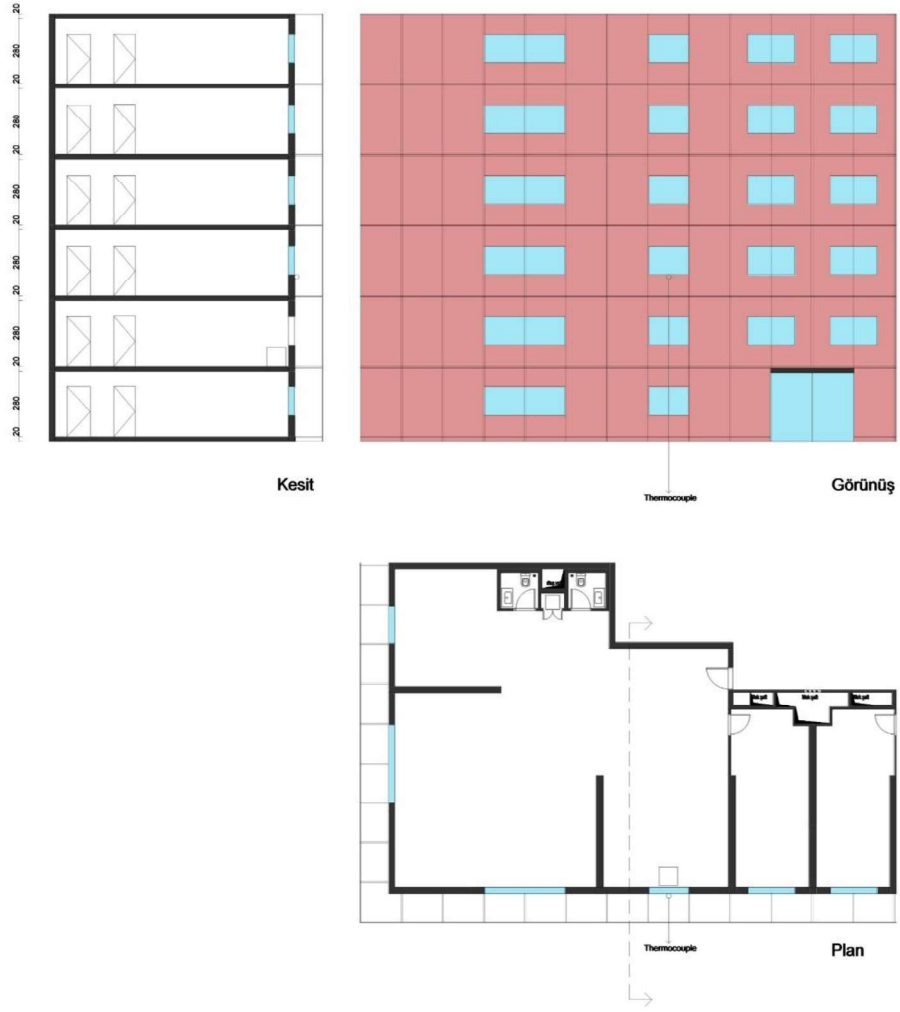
10: A1 modeli plan, kesit ve görünüşü
